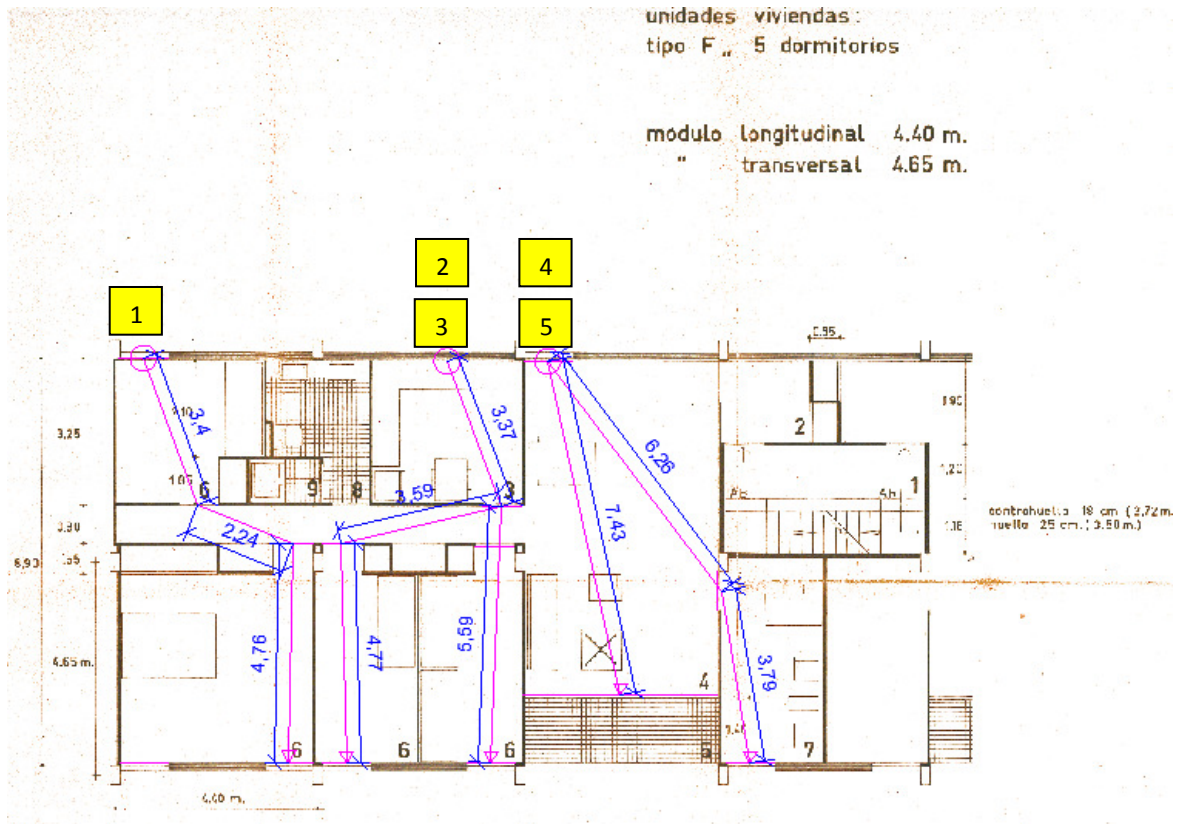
Recorridos del aire entre fachadas opuestas.
